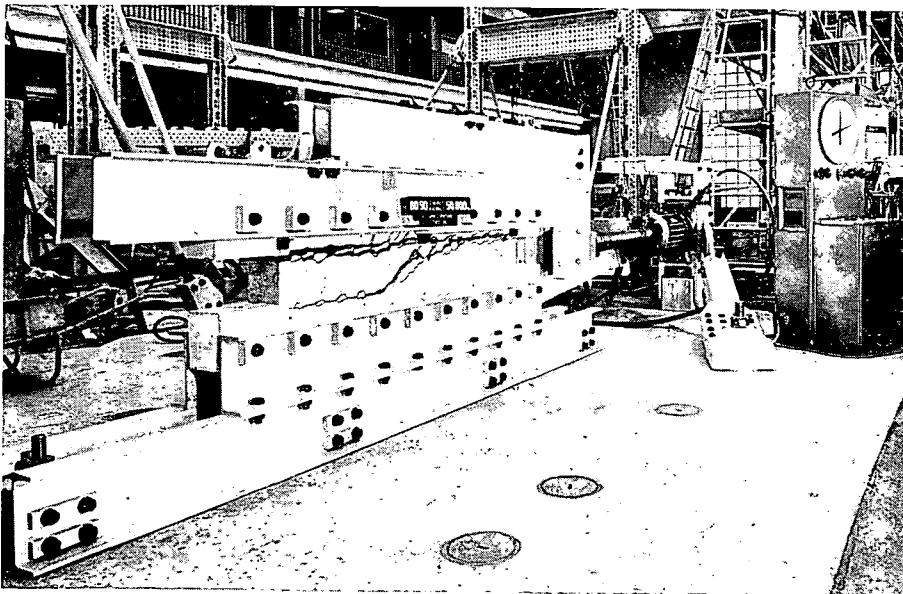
Dispositif d'essai d'un joint entre panneaux préfabriqués, sur la plateforme du C.E.S.
